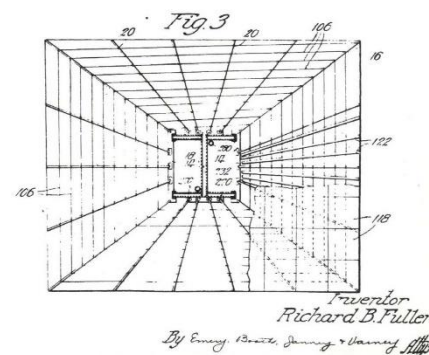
Cubierta 4D House, dibujos patente. Hincley, Russell Walcott Estudio, 1928
